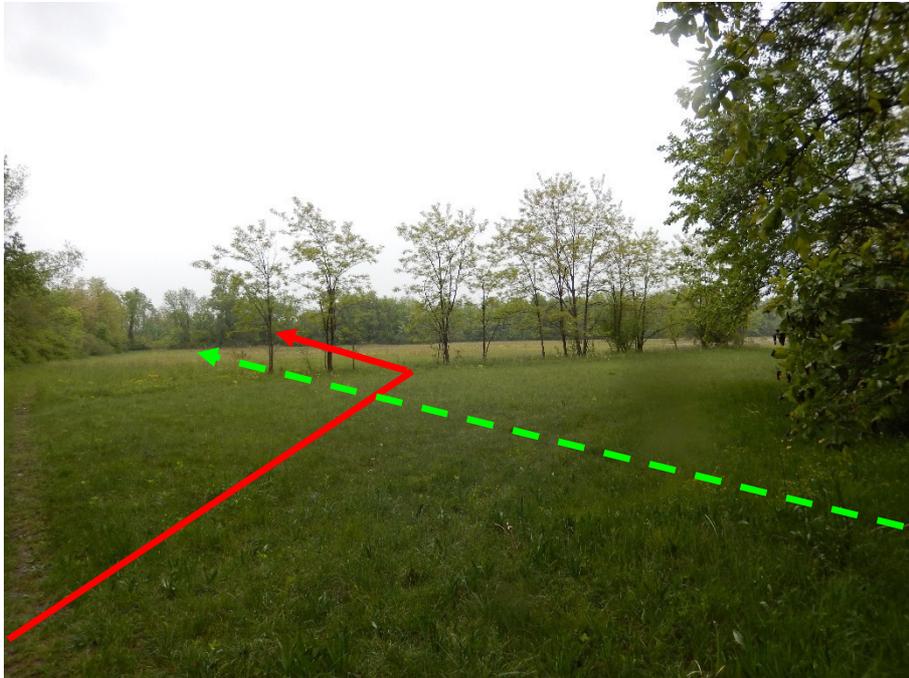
ATTRAVERSAMENTO STR. COMUNALE E INSTALLAZIONE PIDA 1B
